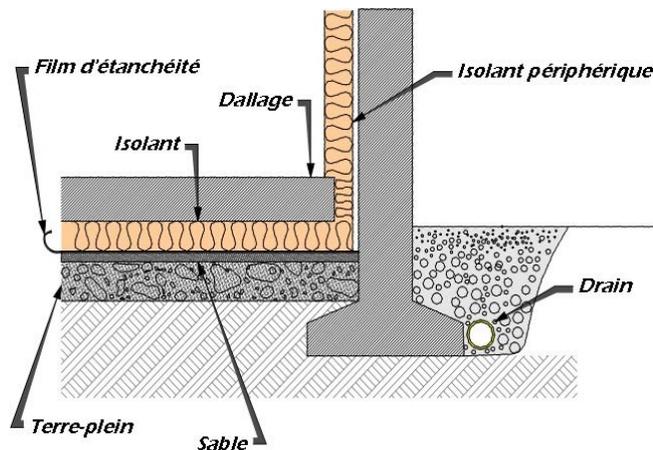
Isolation d'un plancher sur terre-plein (sous le dallage)
